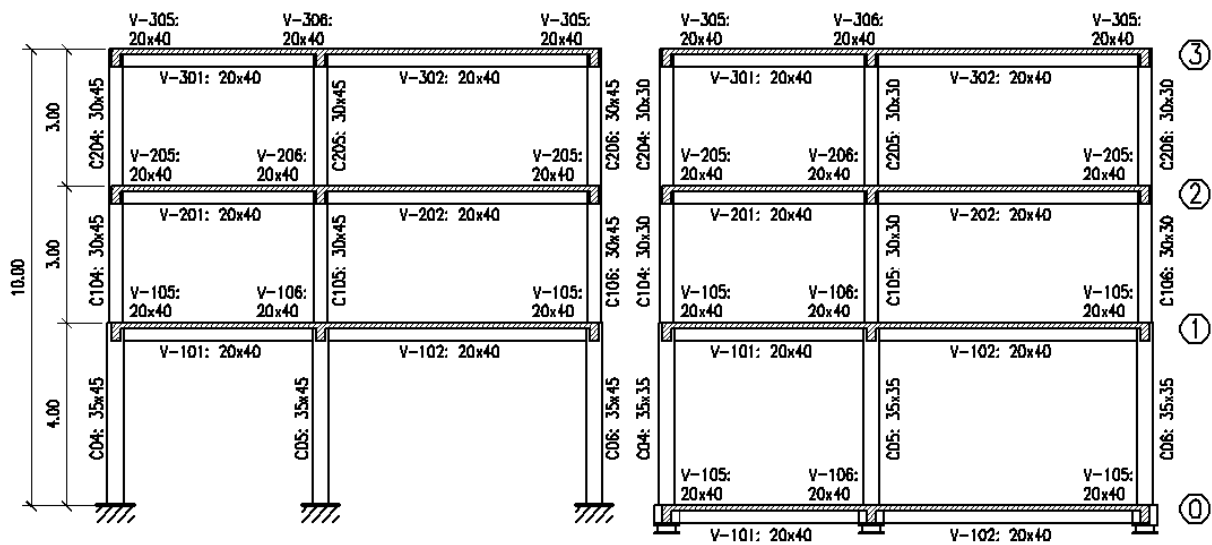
Corte longitudinal de estructura con base fija y base aislada
